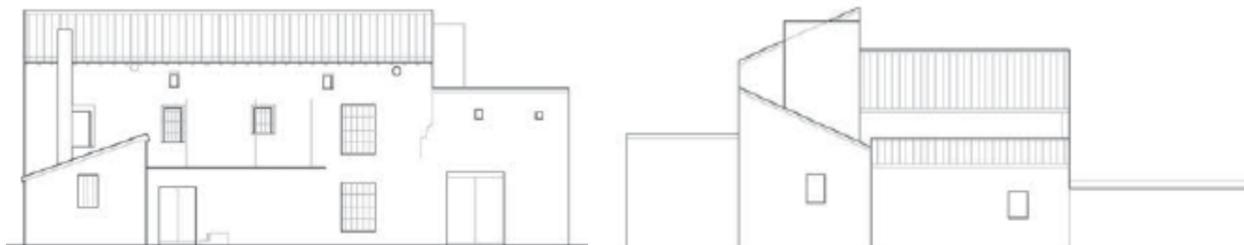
, 35, 36 y 37. Diversas tipologías de casas compactas (;Alquería Pastor, Bentússer; Alquería del Pi, camino de Godella; y Alquería Falcó, camino de Moncada). 2010. Fuente: Arquitectura rural valenciana.
